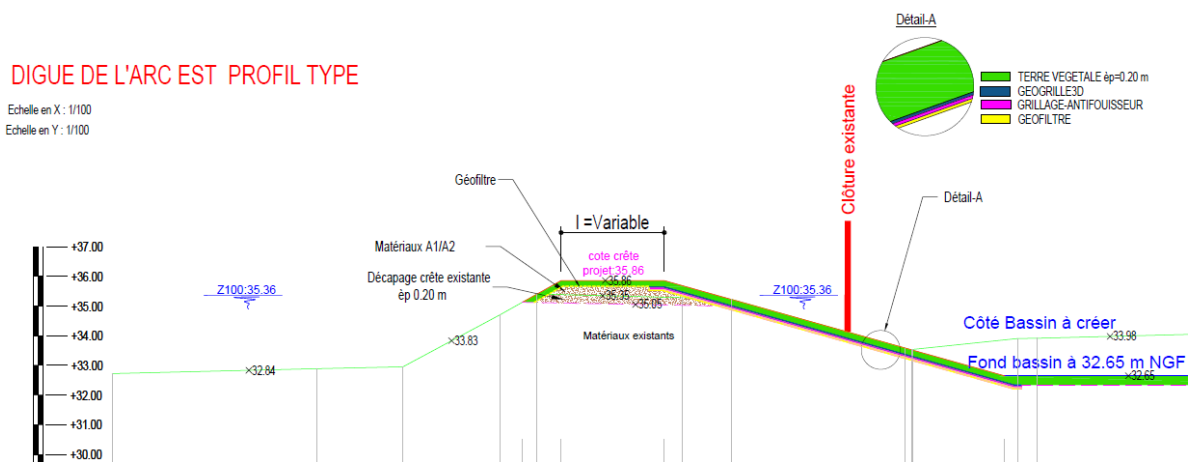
Profil en travers de la digue de l'ARC rehaussée (côté Est)
